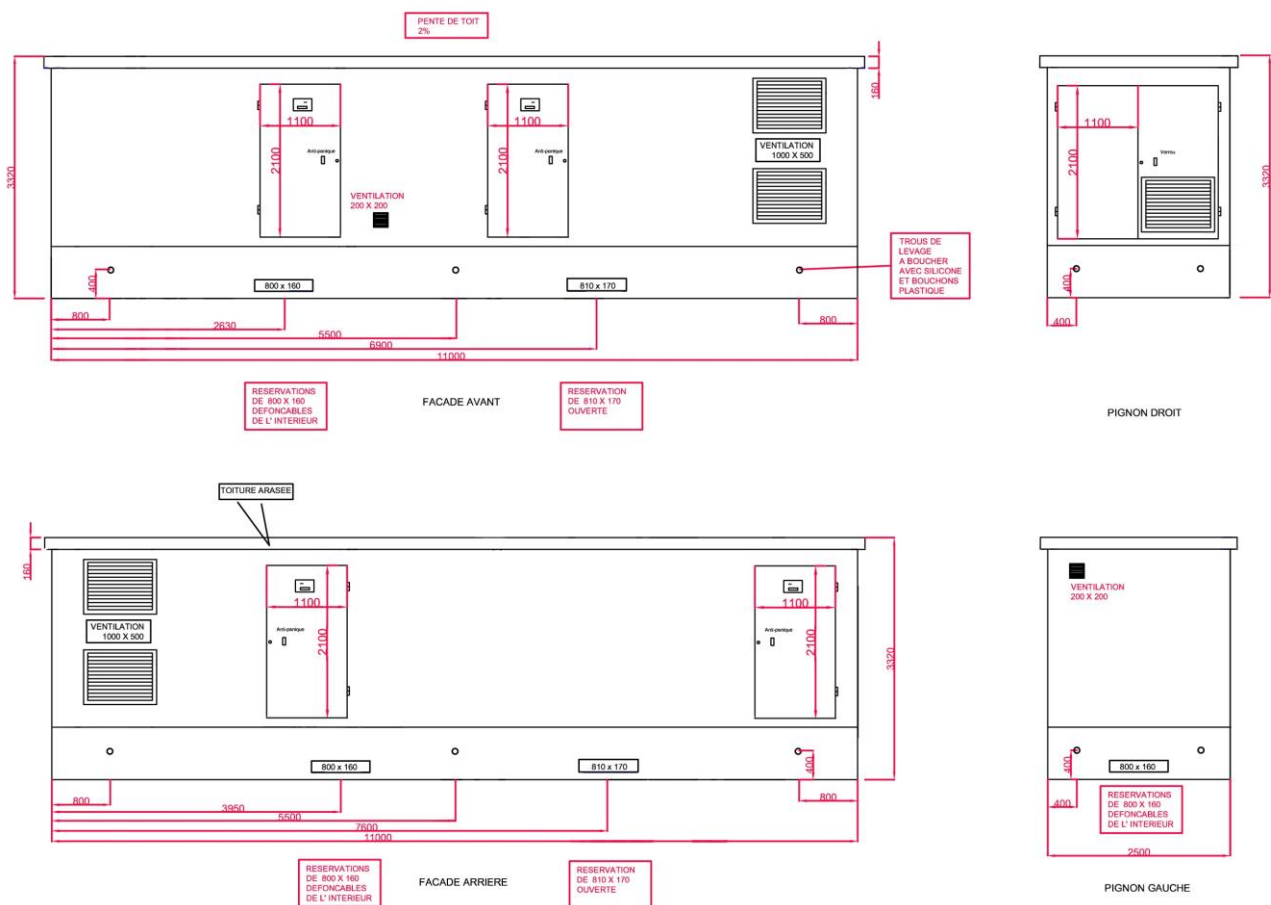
Plan de façade d'un poste livraison simple (PDL1 et PDL2)
